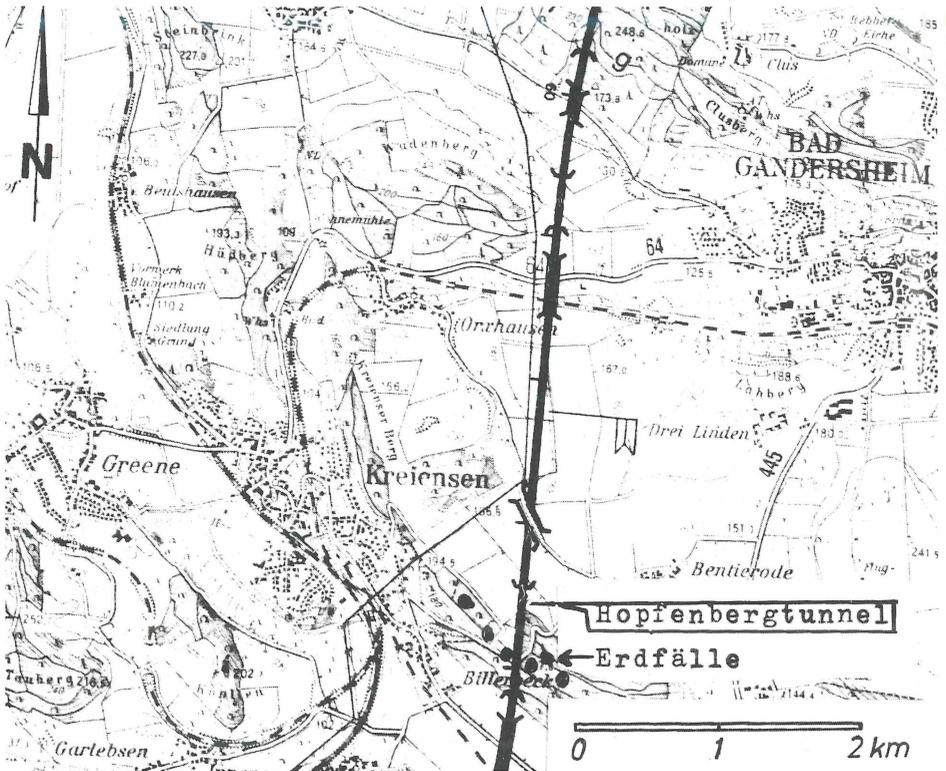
Lageplan (Ausschnitt aus der Streckenkarte)
